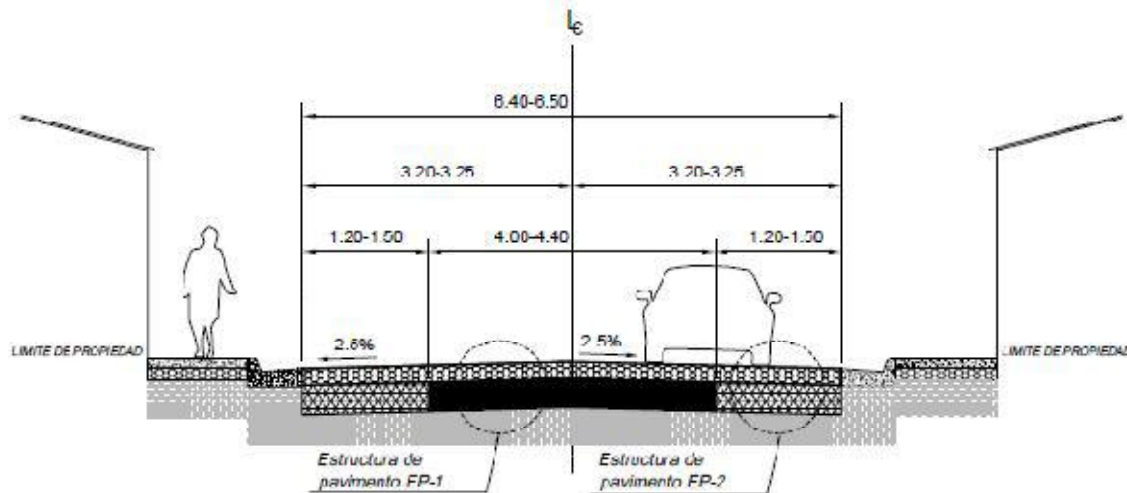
Sección Transversal Tramo 2, Est 0+090 a 0+440.
